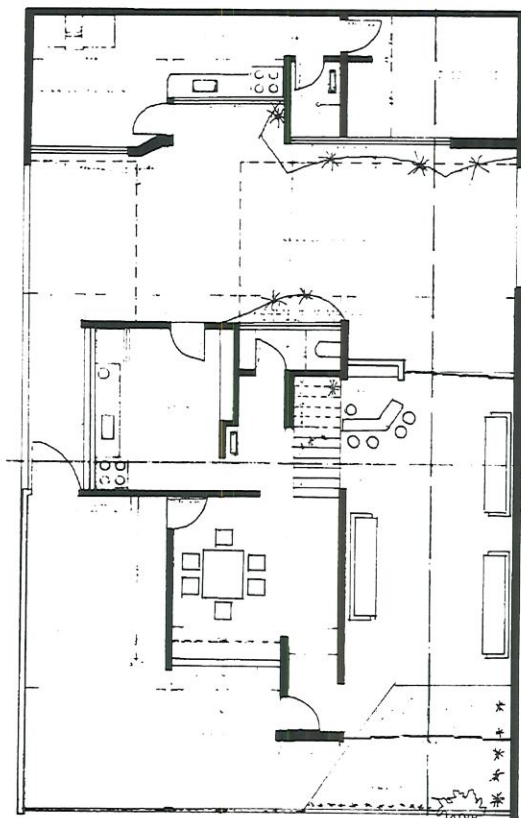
Residência Baicker Bernardino – 1963 – Planta Térreo
